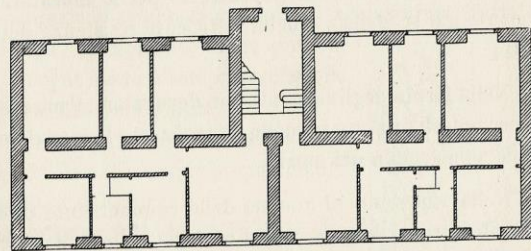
Disposizione planimetrica dei muri principali per la formazione di maglie chiuse negli edifici in muratura.
